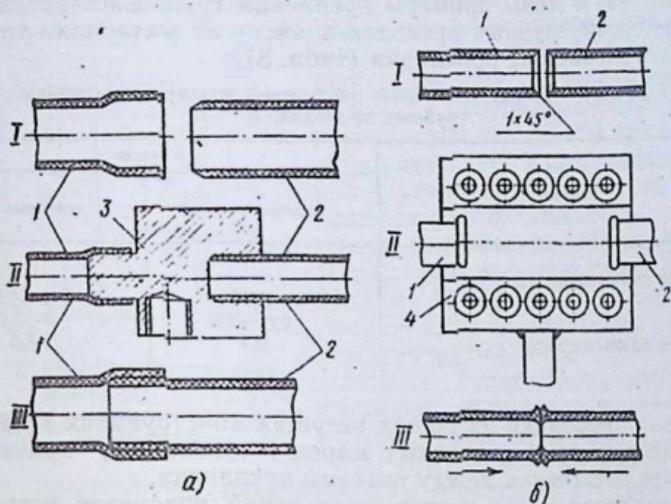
Сварка полиэтиленовых труб внастроб (а) и встык (б): I — подготовка концов труб под сварку, II — оплавление труб, III — сваренный стык; 1, 2 — соединяемые трубы, 3 — металлическая оправка, 4 — электроразвальцеватель
